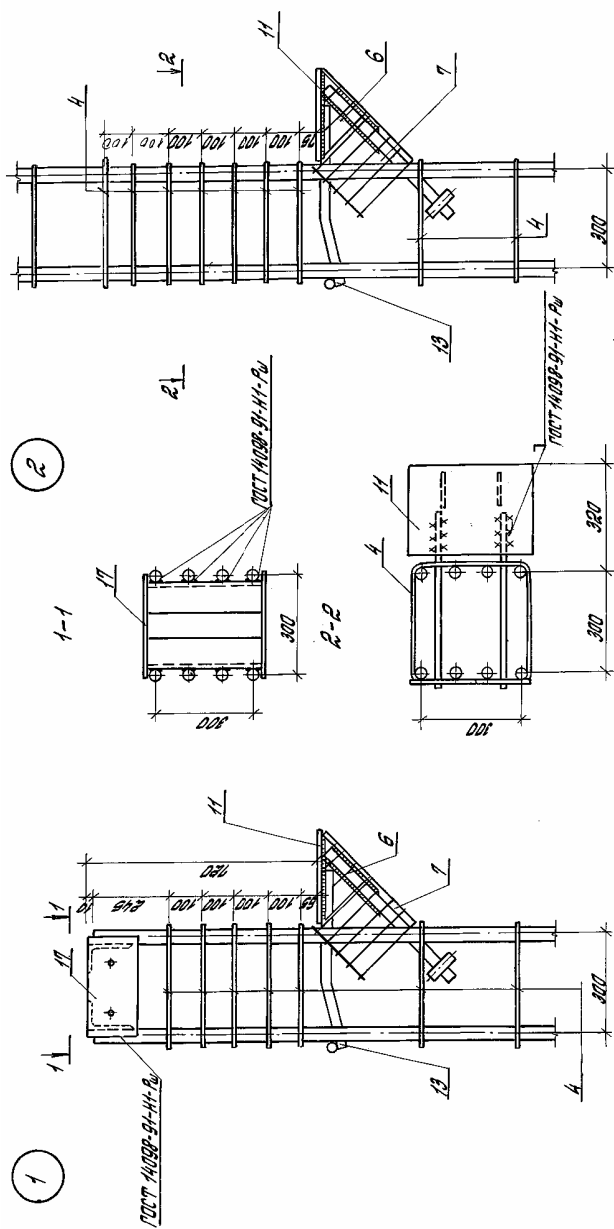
Пространственный каркас крайней колонны: 1 – рабочие угловые стержни продольной арматуры; 2 – рабочие промежуточные стержни продольной арматуры; 4 – хомуты; 6, 7 – каркасы с наклонной арматурой консоли; 8 – сетки косвенного армирования стыковой зоны колонны; 9 – сетки косвенного армирования конечного участка колонны; 11 – арматура консоли; 15 – крестовое соединение продольных стержней (см. рис. 6.10) для обеспечения положения стержней в момент бетонирования; 18 – центрирующая пластина
